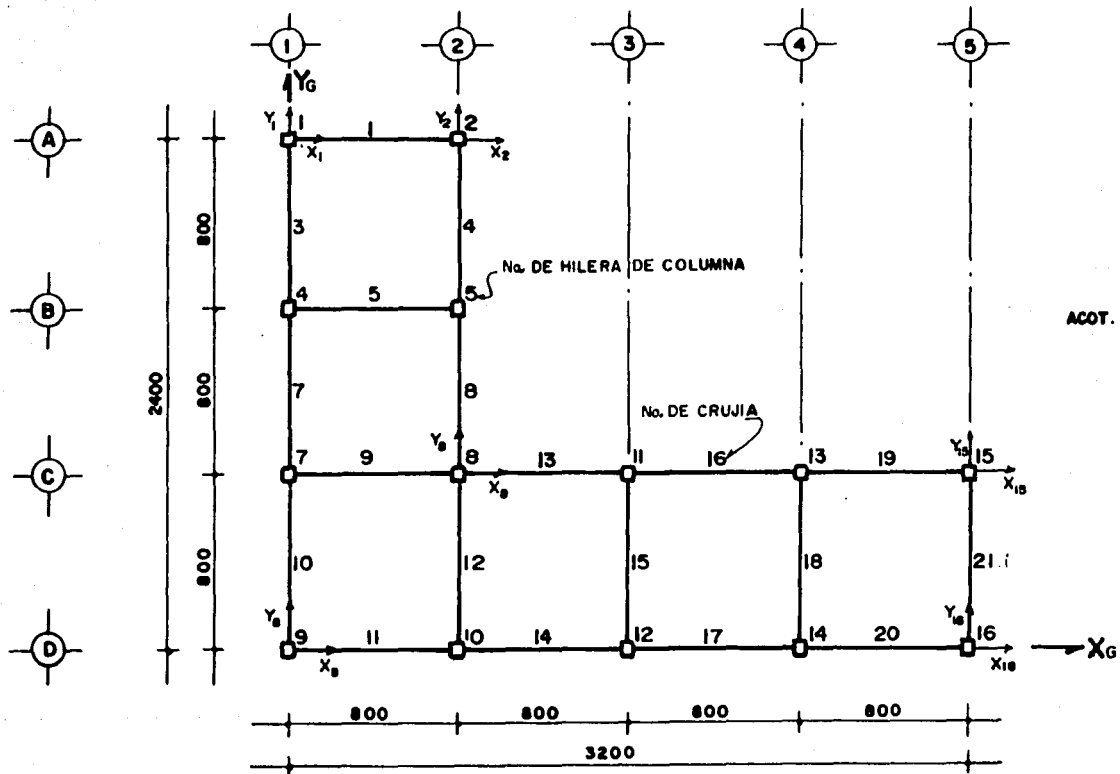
IDEALIZACION DE LA ESTRUCTURA.
